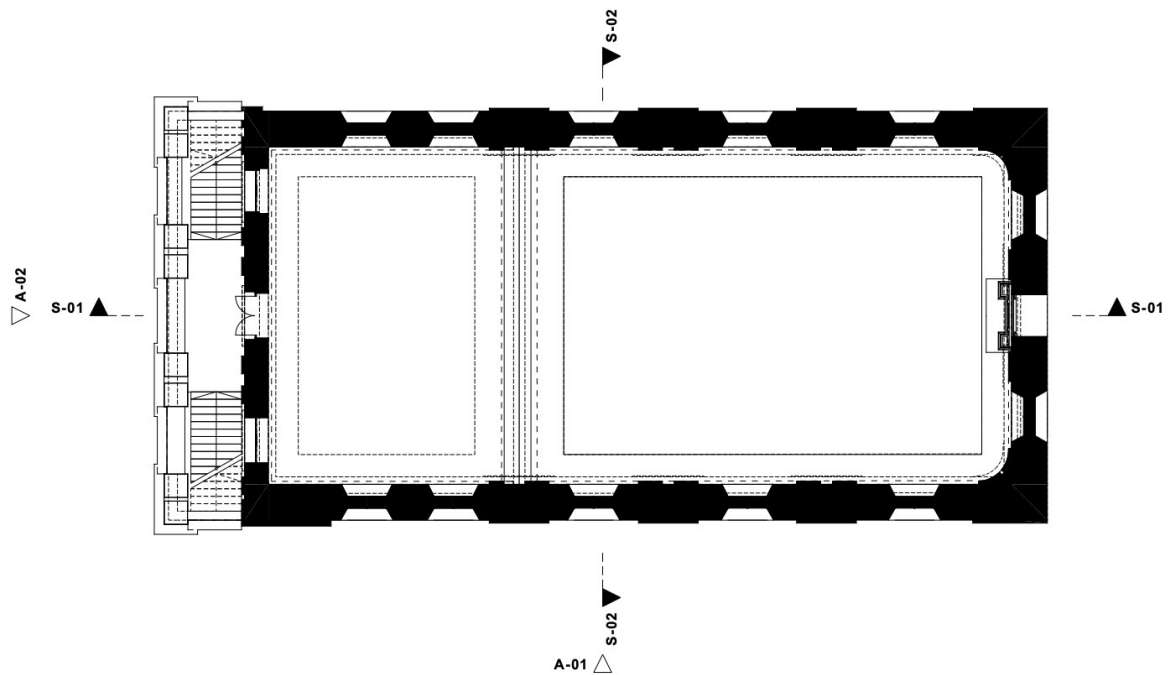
Rekonstruktion Grundriss 1. OG
